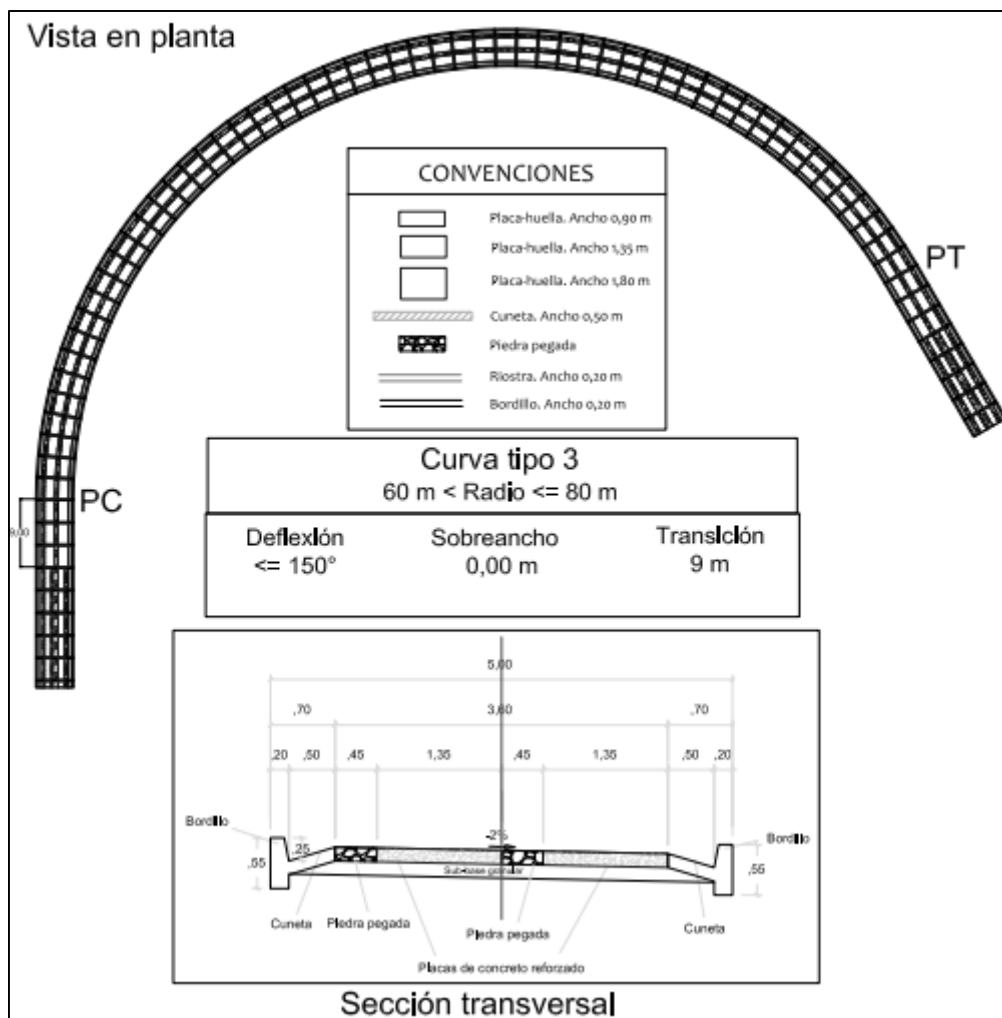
Diseño estructural con corte transversal y vista en planta para el duodécimo tramo, curva 6.
